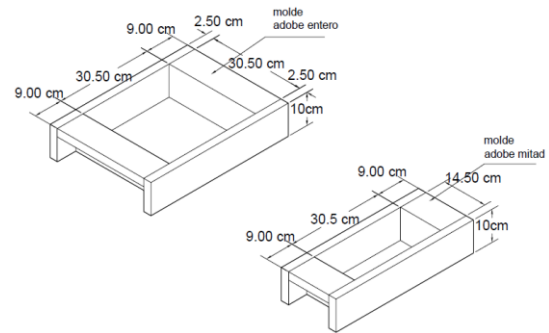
Dimensión de moldes para elaboración de adobes.
